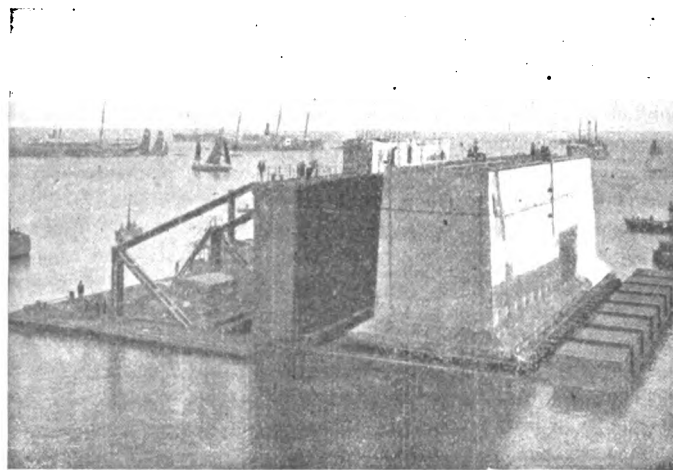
Vista del dock galleggiante con masso cellulare. - Vista.
